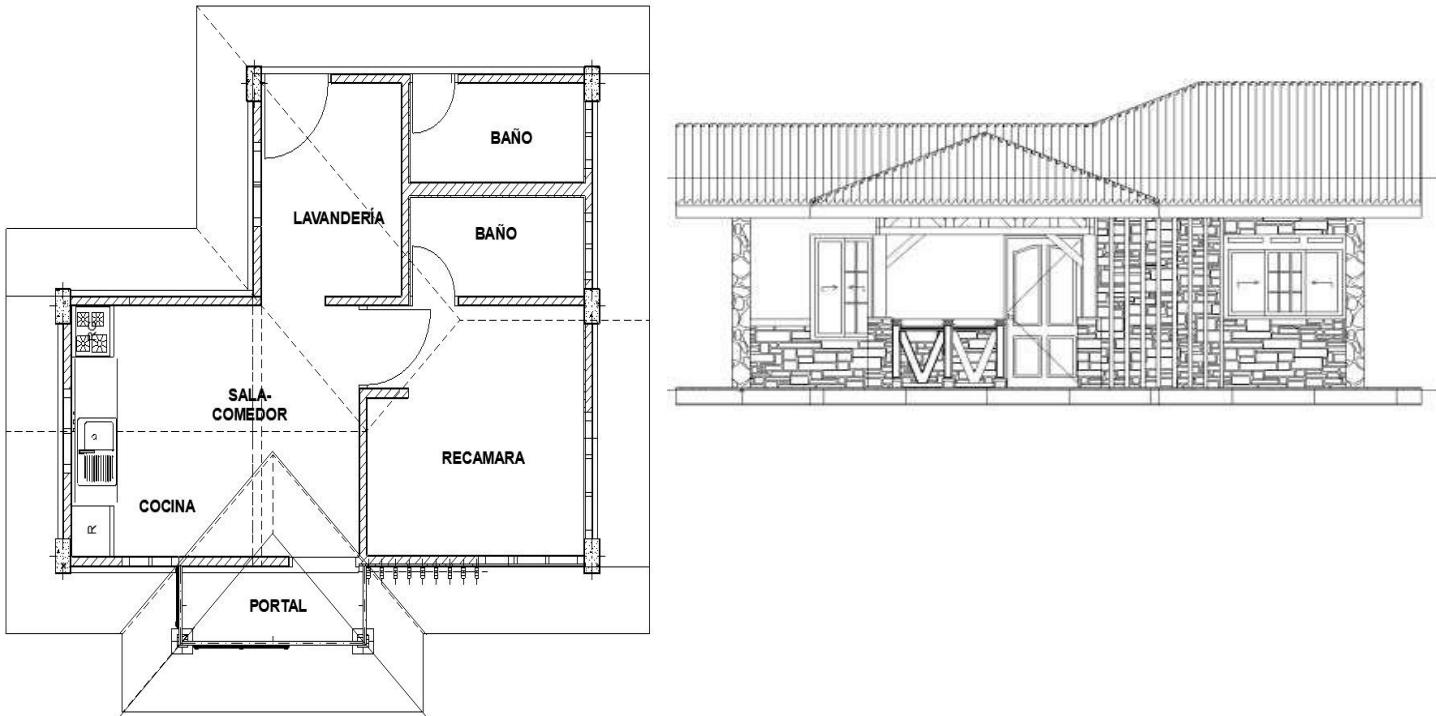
Planta arquitectónica y diseño frontal de CASA DE CELADOR
